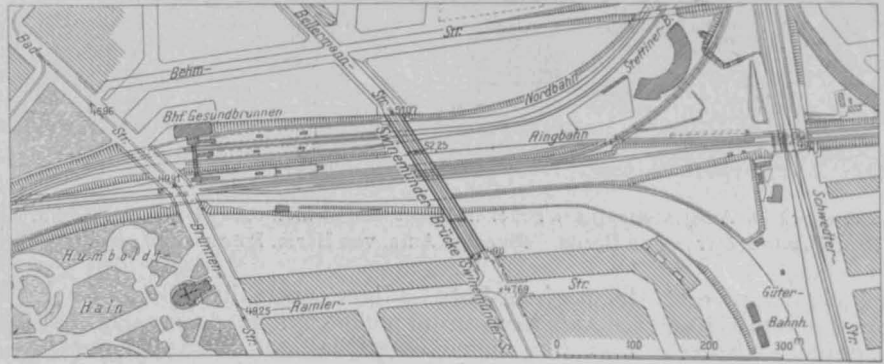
Lageplan der Swinemünder-Brücke in Berlin.
